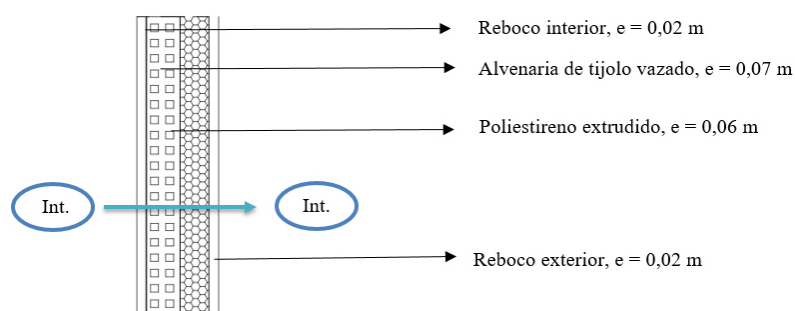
Pormenor construtivo das paredes interiores na zona de ENU
